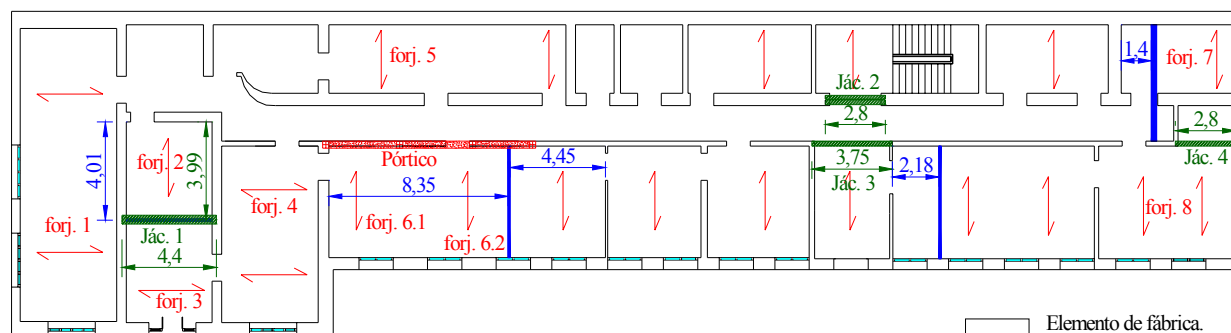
Esquema en planta de los forjados y muros portantes y dinteles de un edificio objeto de rehabilitación.
